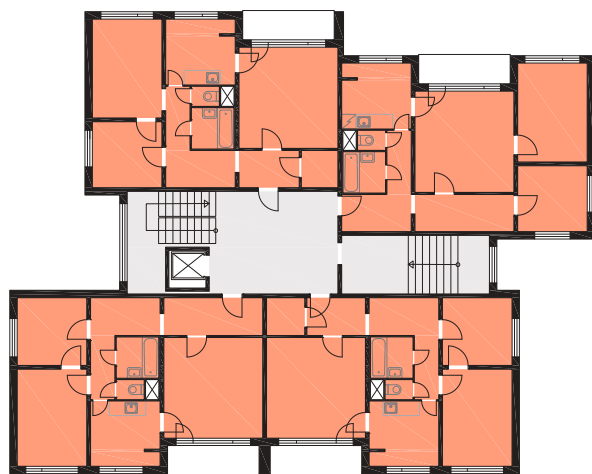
Konstrukční soustava OP 1.11 (Zdroj: panelaky.info)
